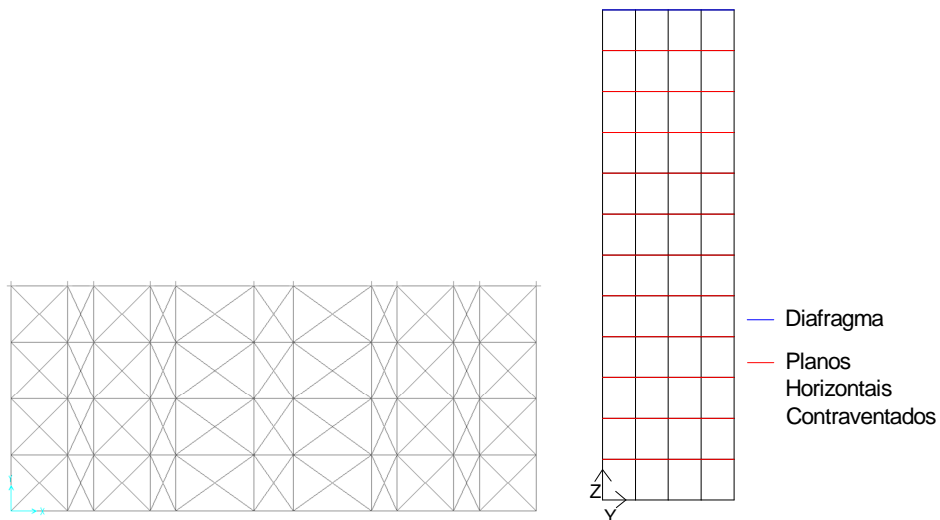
Configuração dos Planos de Contraventamento Horizontal Com Elementos de Contraventamento Pequenos
